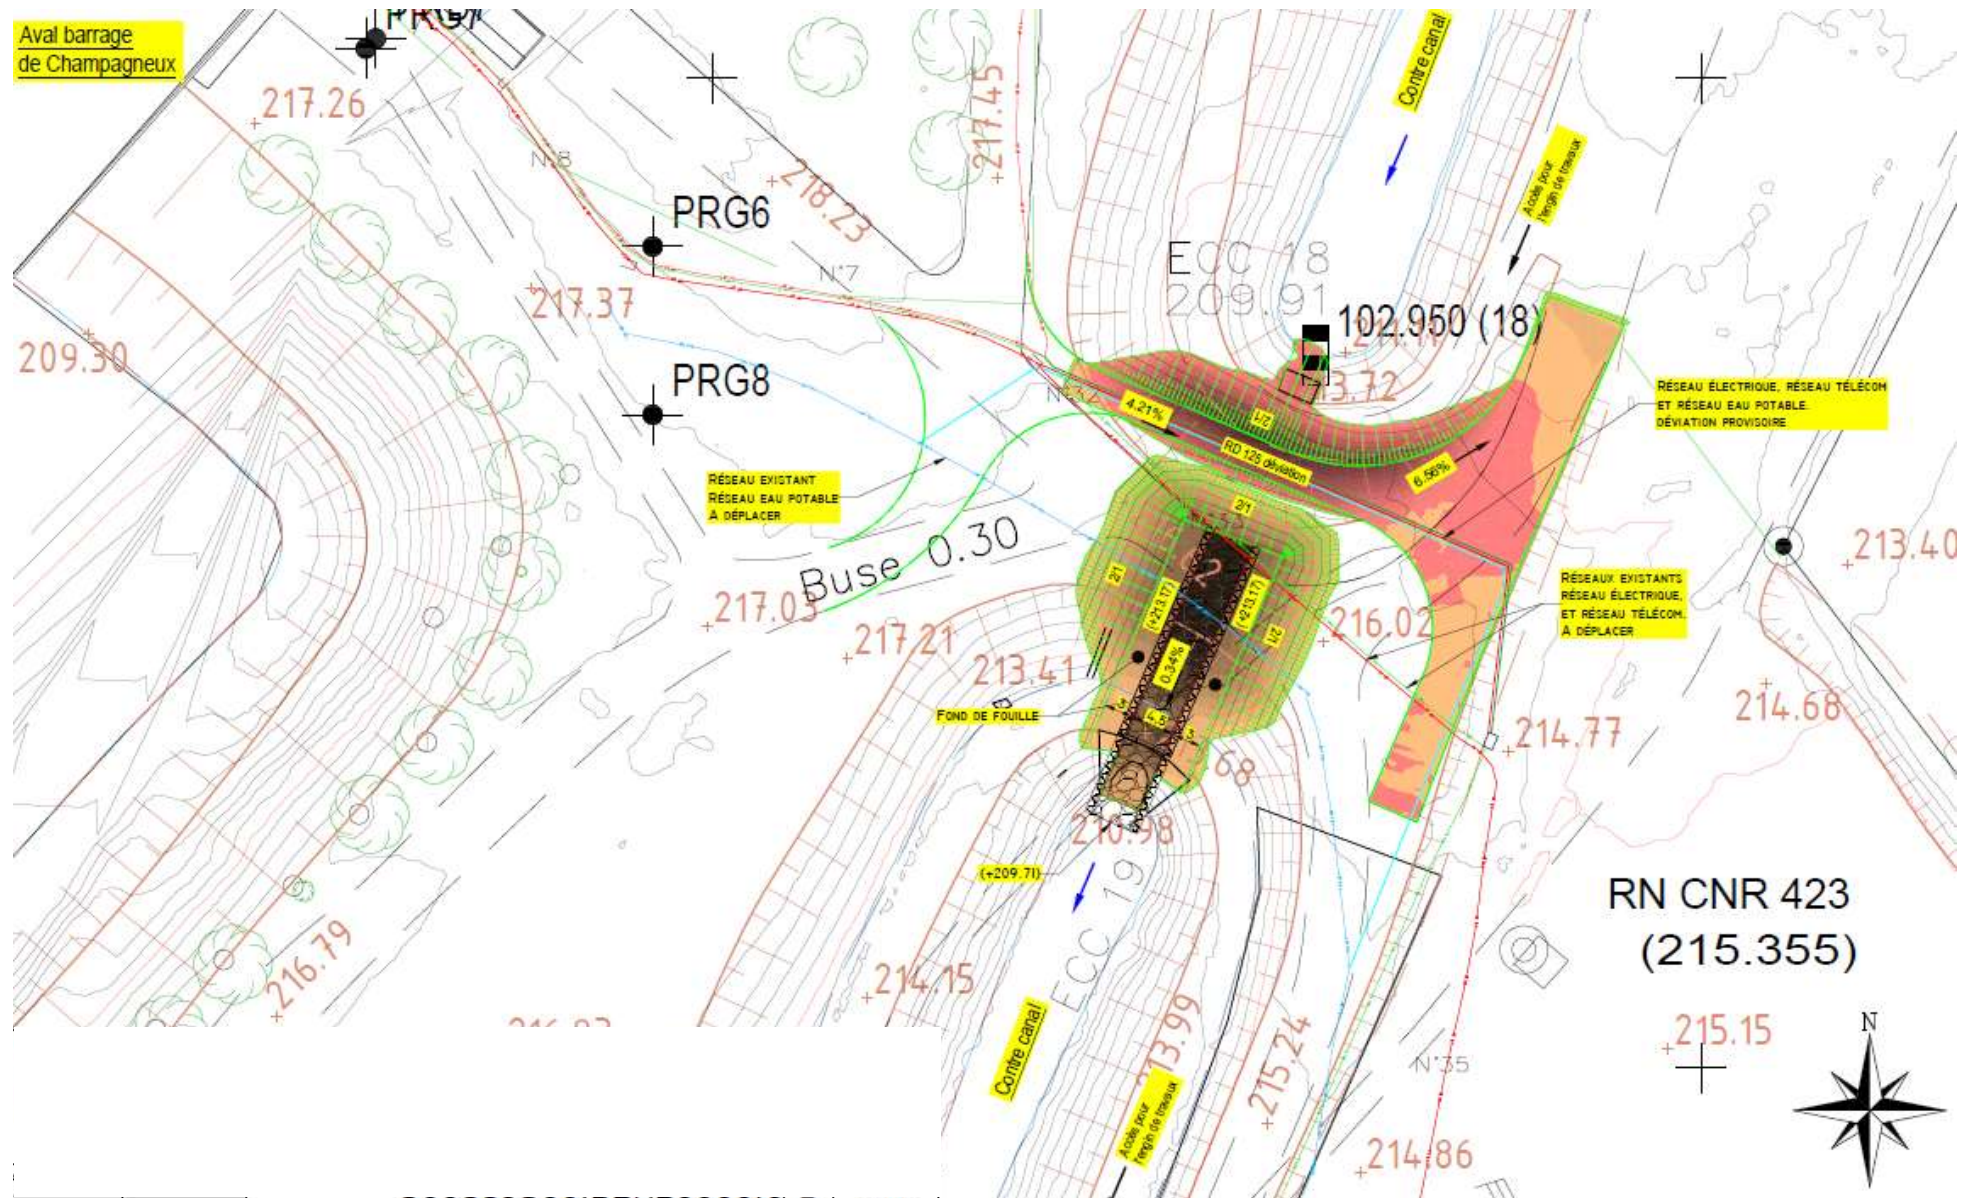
Plans décrivant les travaux – Phase 3.1 – Remplacement de la buse sur la partie aval – Vue en plan.
